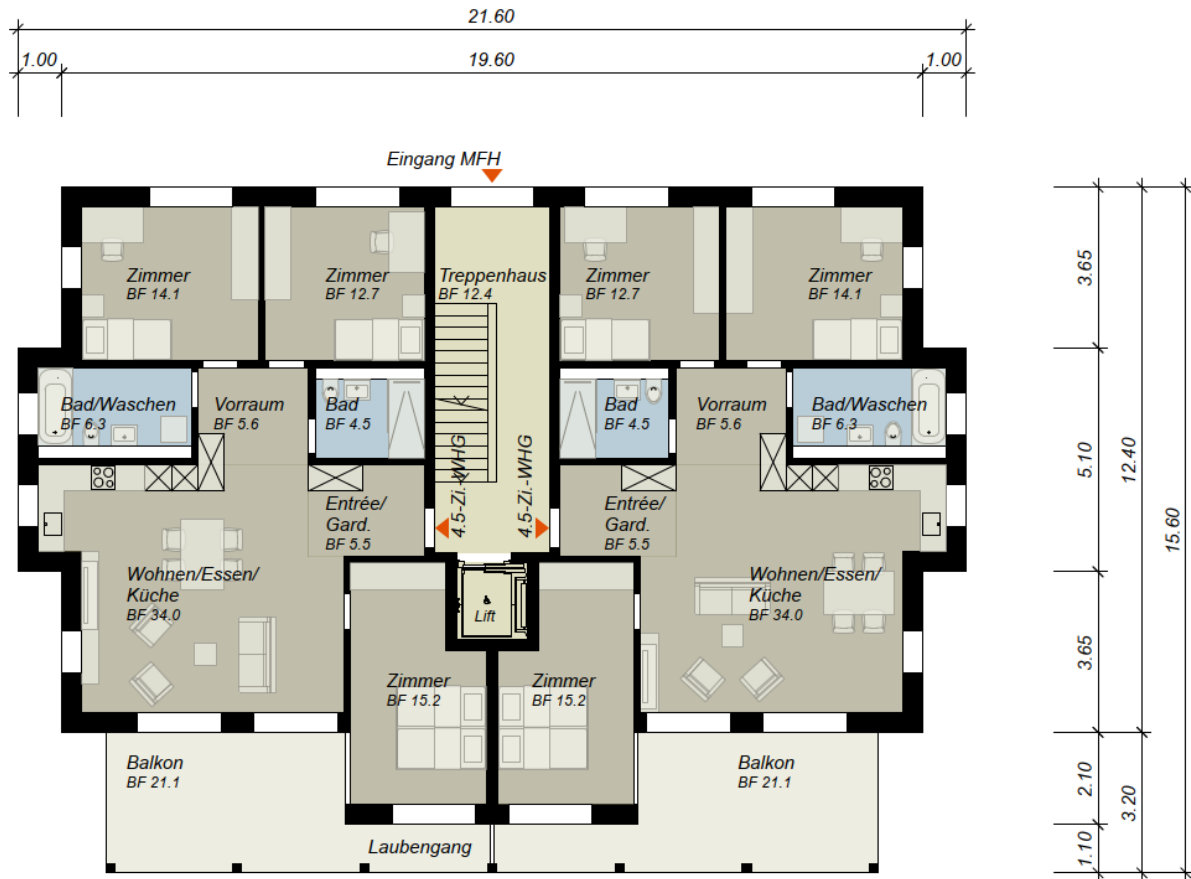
Überbauung Oberdorf, Grundriss Obergeschosse, Bischoff & Partner Architekten AG
